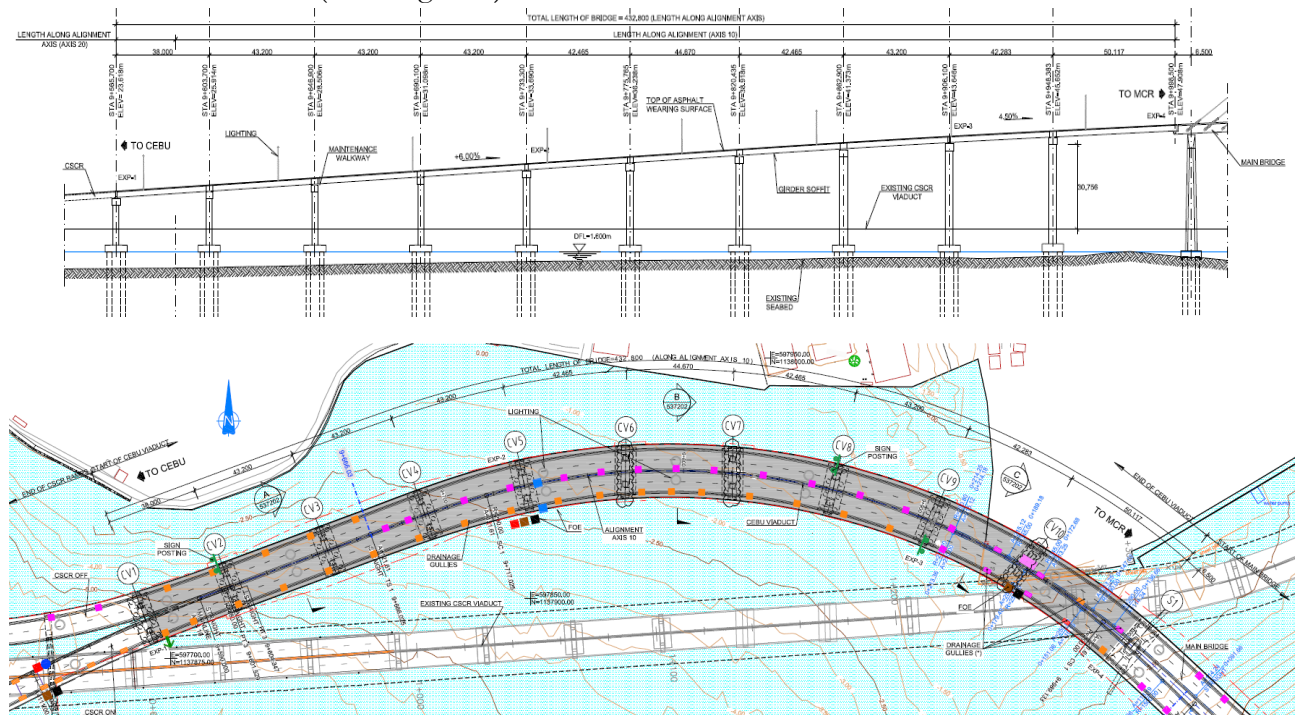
Vista en Alzado y Planta del Viaducto de Cebú
